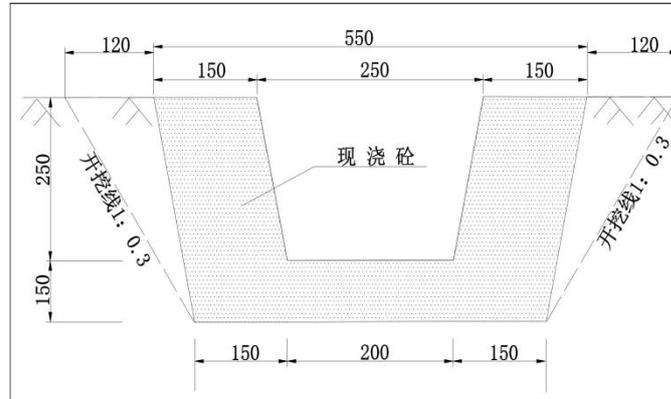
+100m 以上台阶平台区坡脚排水沟横断面图 (单位: mm)
